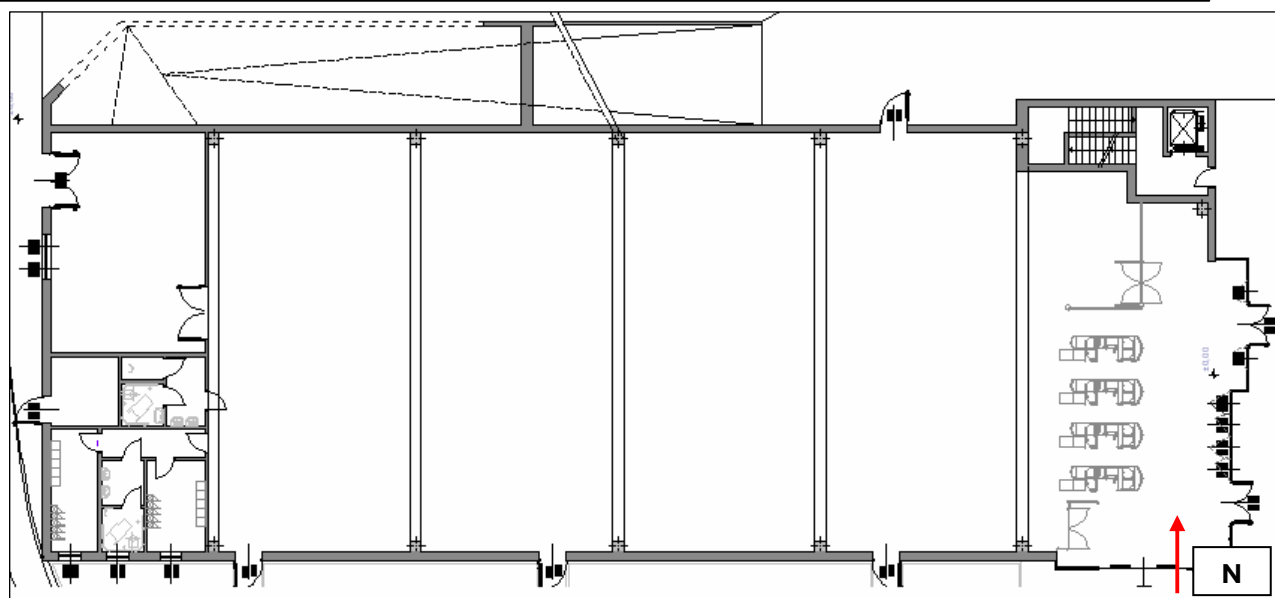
Progetto architettonico: planimetria PT lotto n. 3
